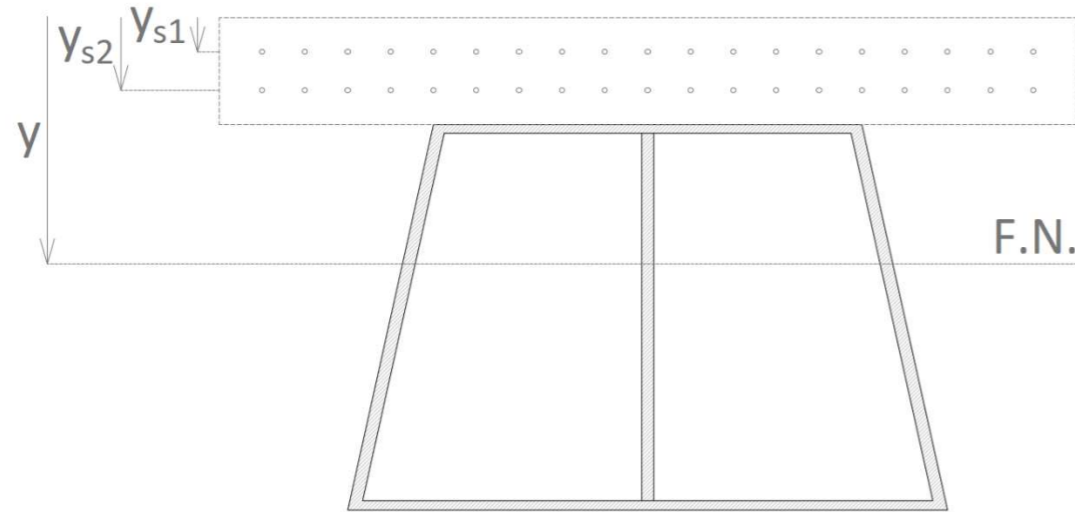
Sección fisurada (fuente: elaboración propia)
